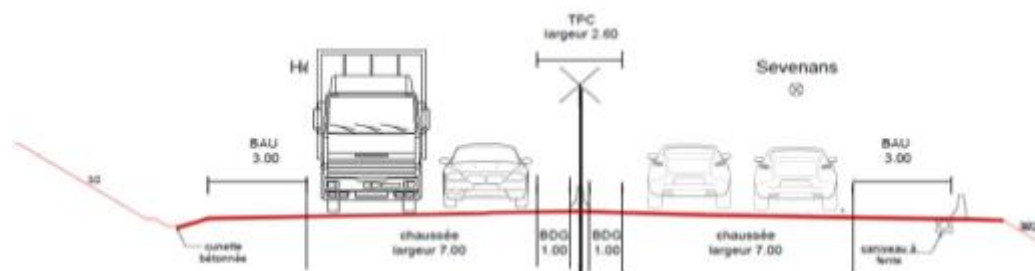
profil en travers prévu pour la nouvelle section – source : dossier
